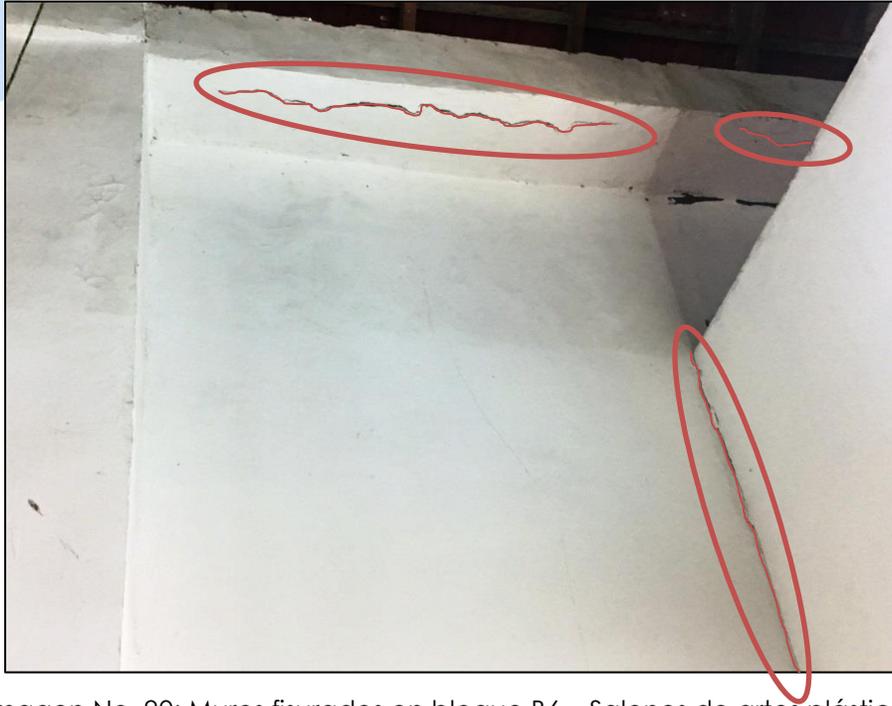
Muros fisurados en bloque B6 – Salones de artes plásticas
